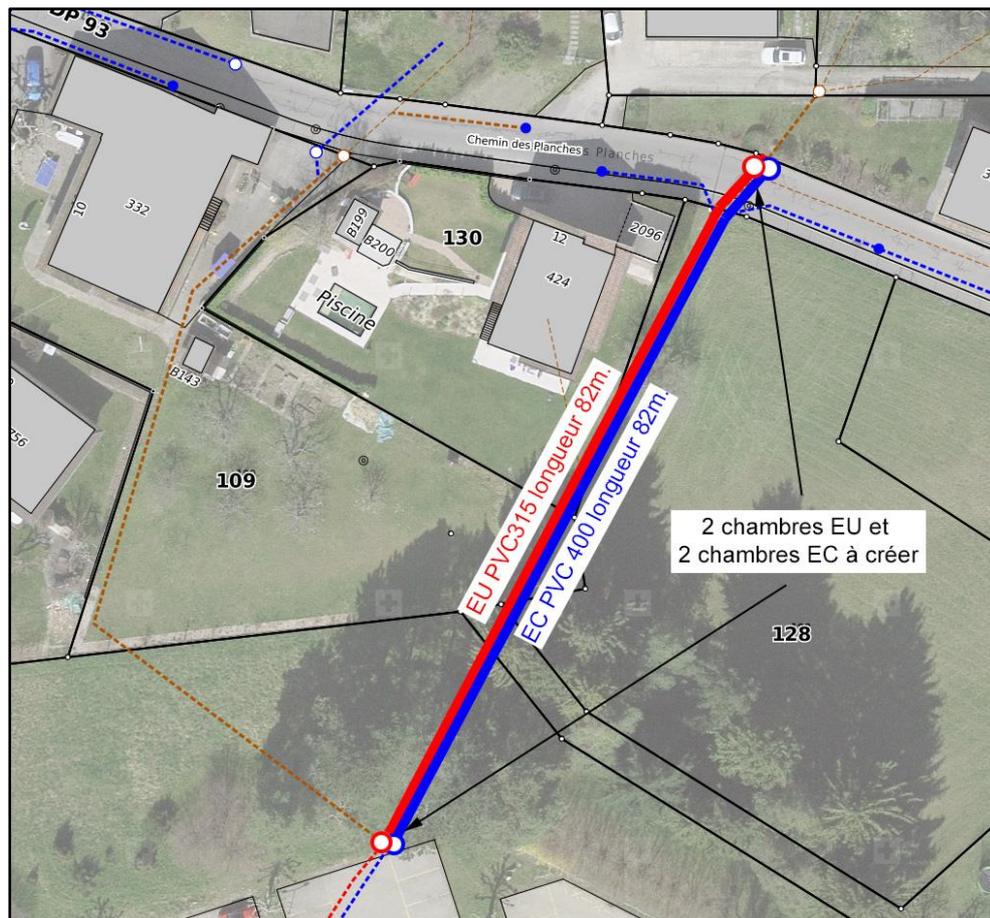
Plan des travaux dans le secteur des Planches/Boveresses
